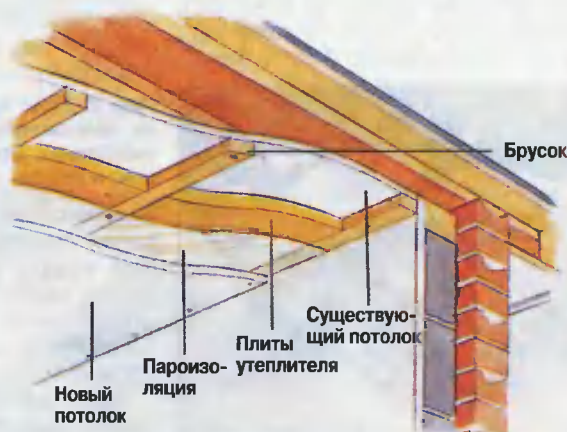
Крышу с исправной кровлей можно утеплить, установив теплоизоляцию под потолком. Ее закрывают пленкой пароизоляции и делают новый потолок из сухой штукатурки
